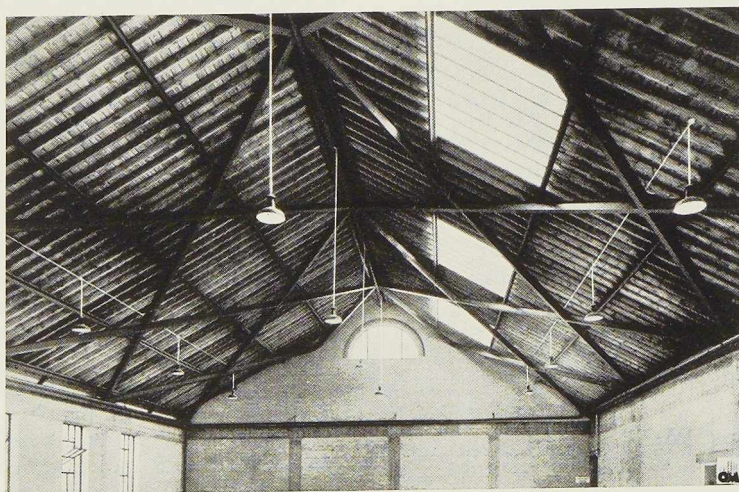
Toiture grillagée à éléments diagonaux d'un hall sportif à Londres.
